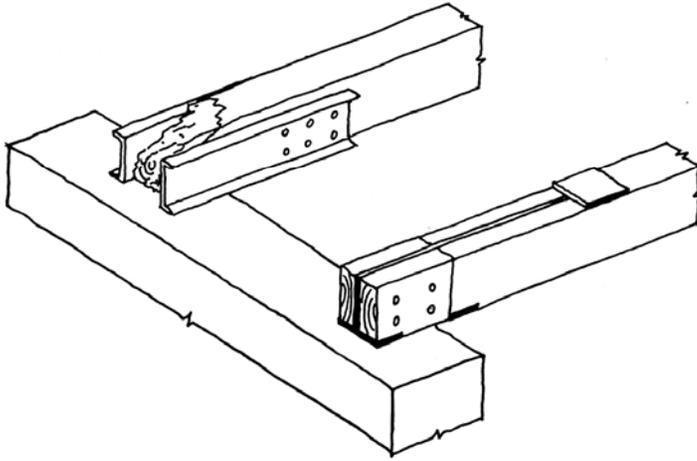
Aumento de la longitud de la viga mediante perfiles metálicos.
